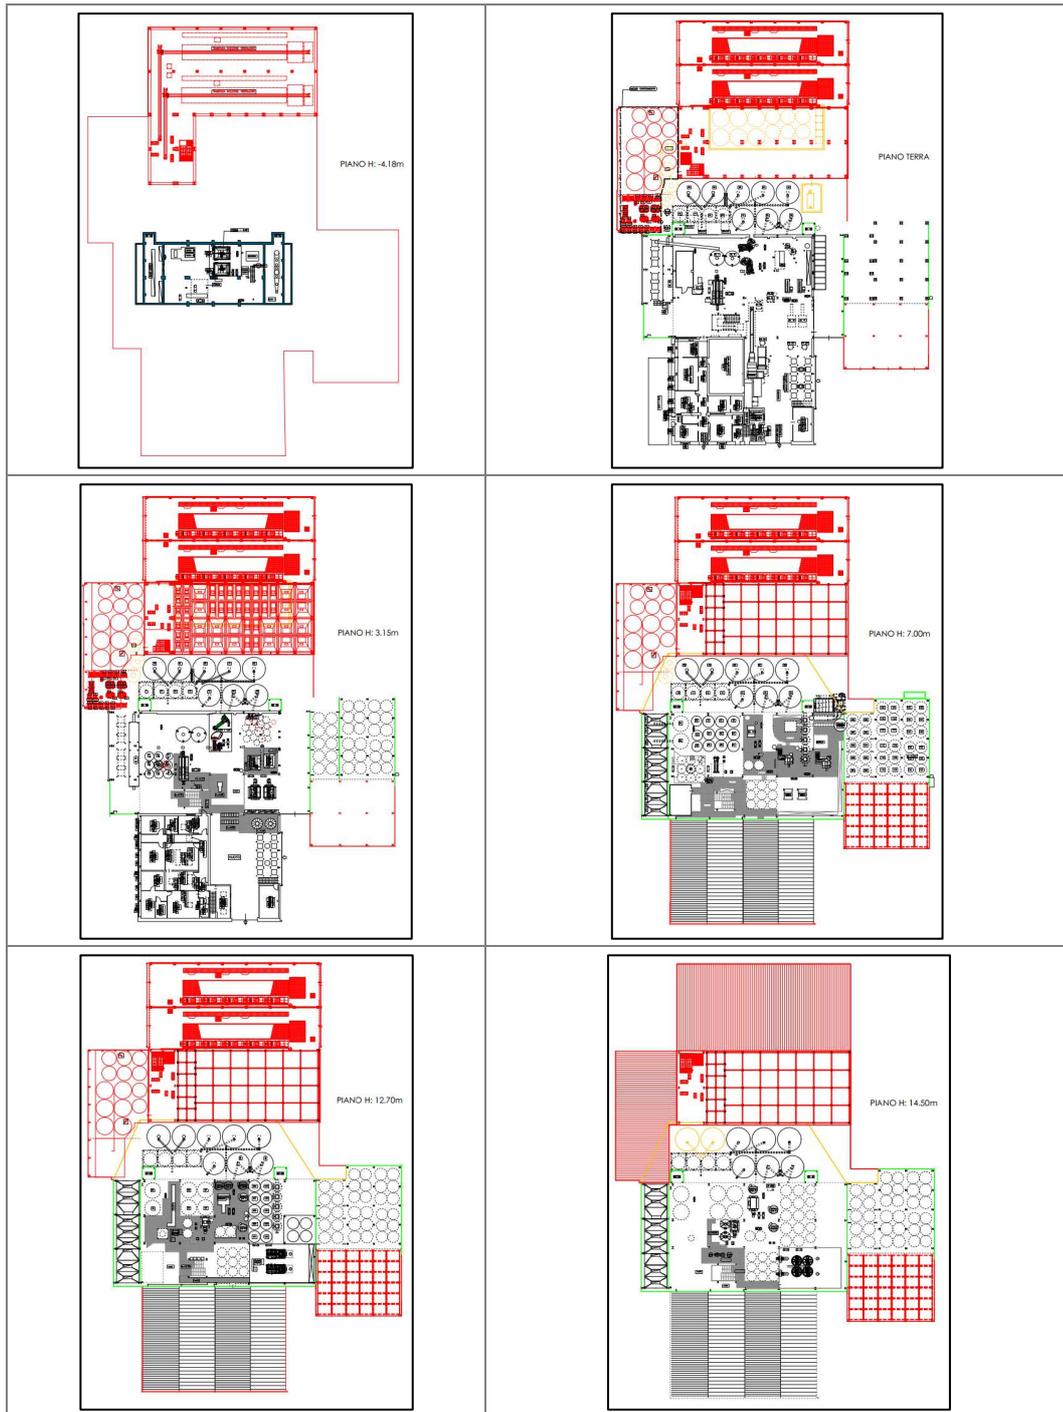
ESTRATTI PROGETTUALI LAYOUT INTERNO STRUTTURA PRODUTTIVA (SUDDIVISIONE PER PIANI)
